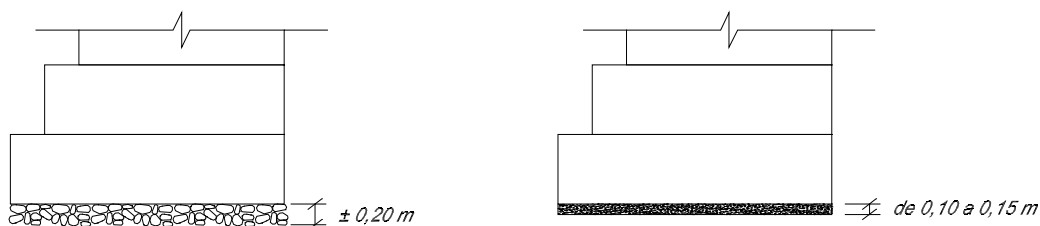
Detalhe da preparação do terreno na cota de apoio da estrutura.
